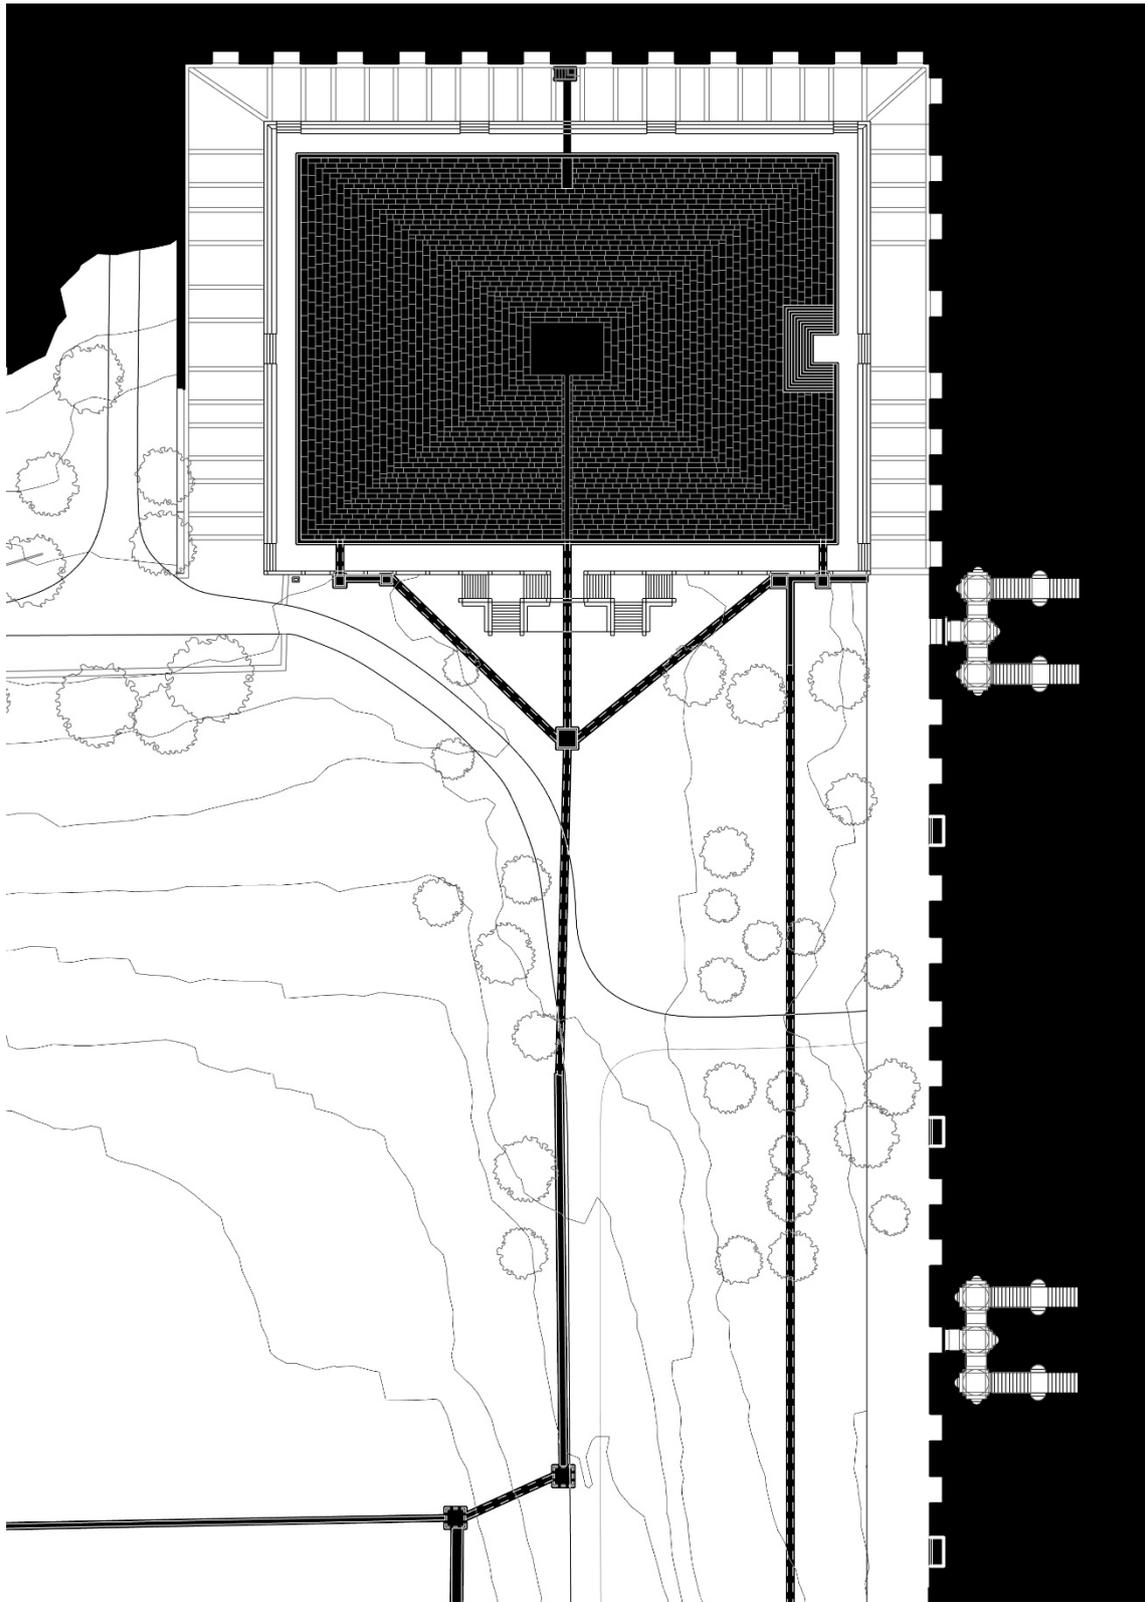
Planta del estanque y conducciones del sistema de riego en la huerta.
